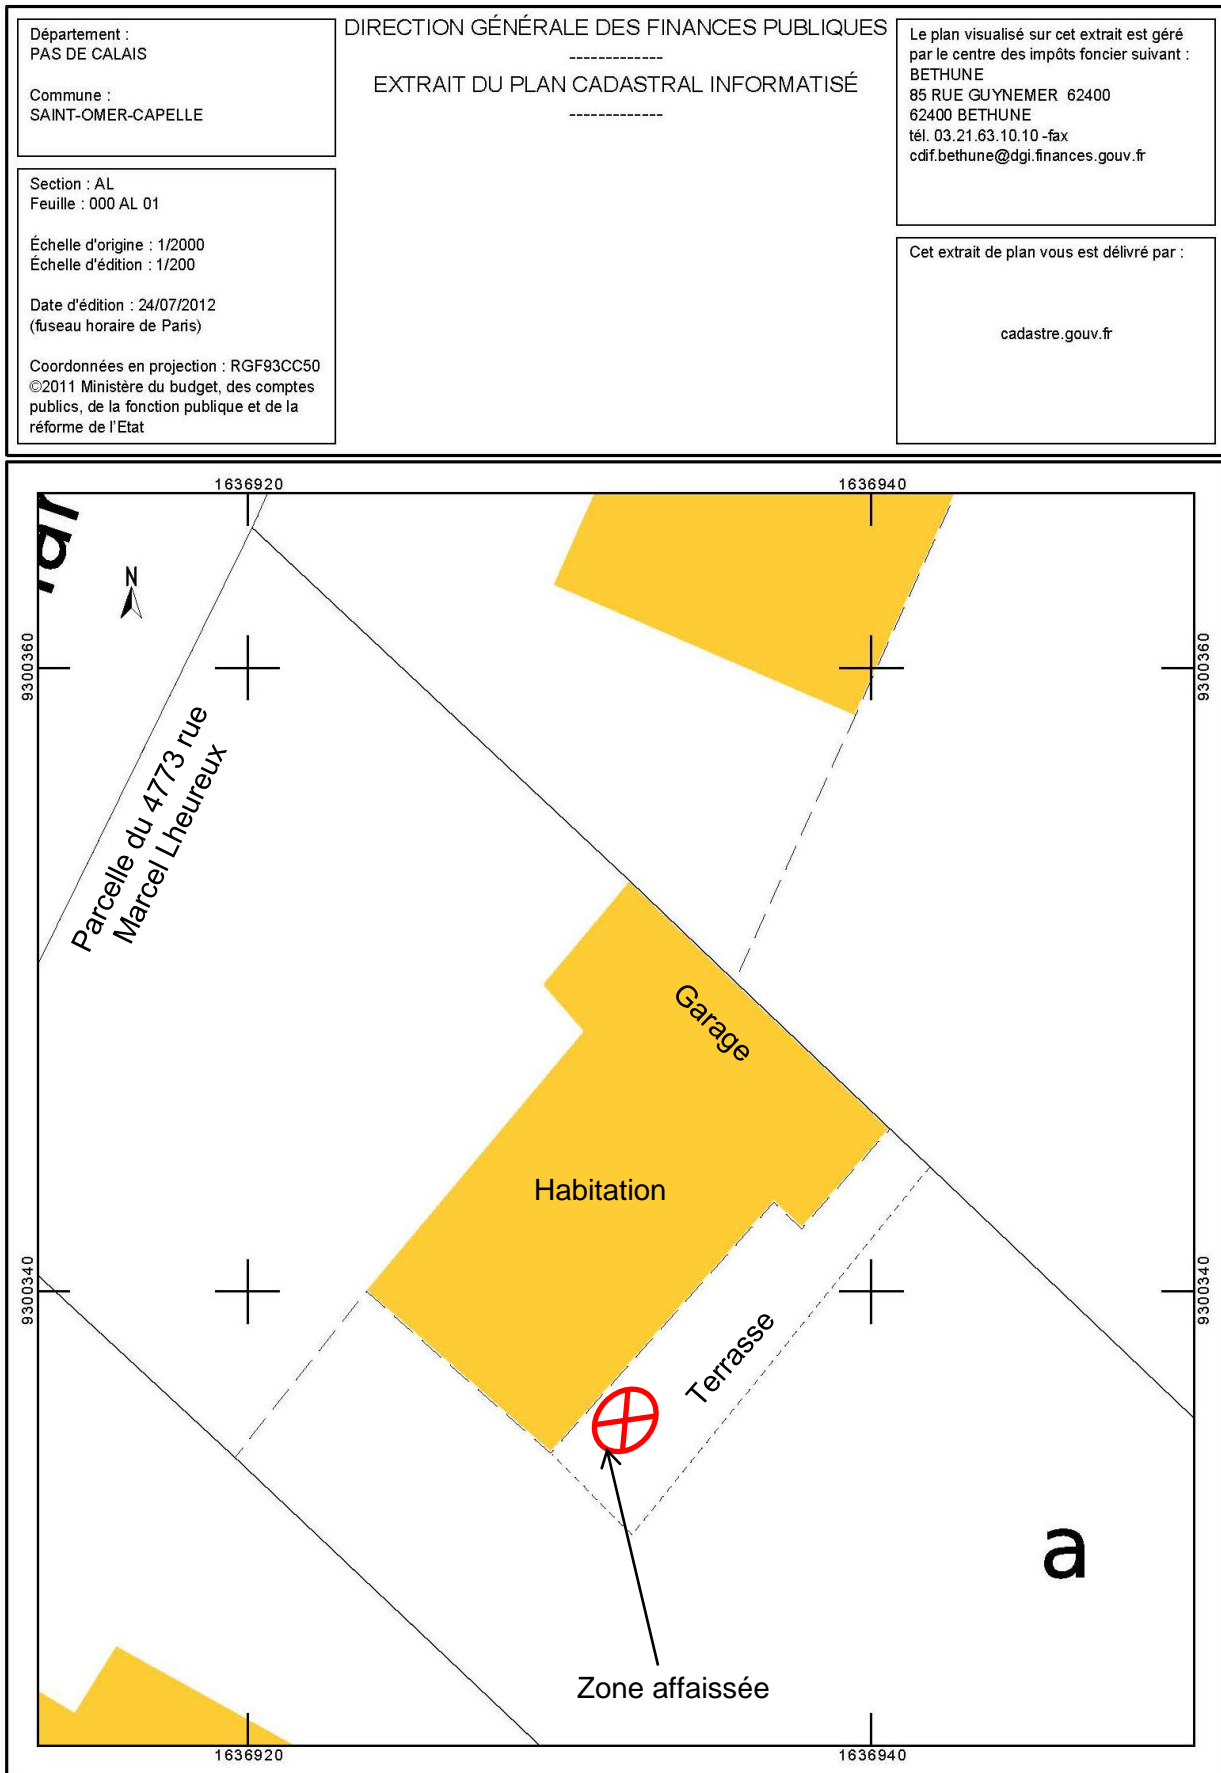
Localisation des désordres sur les bâtiments sur plan cadastral (fond de carte extrait du site www.cadastre.gouv.fr)
